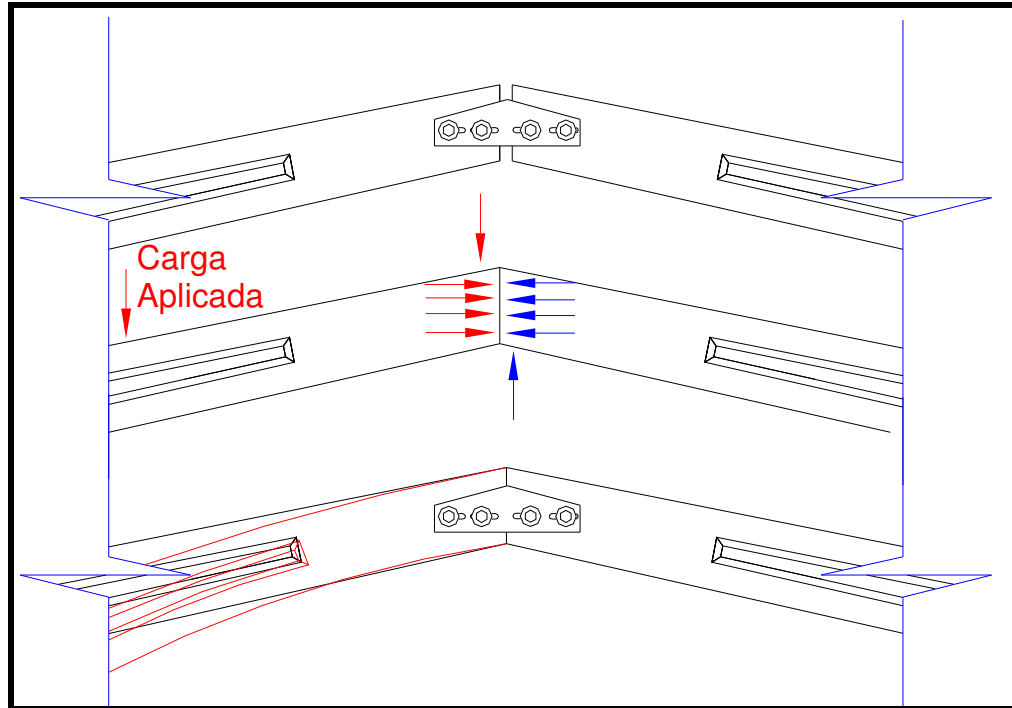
Mecanismo de travamento da ligação viga-viga
